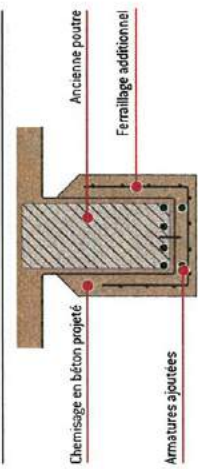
Exemple de renforcement d'une poutre par béton projeté (coupe transversale)
